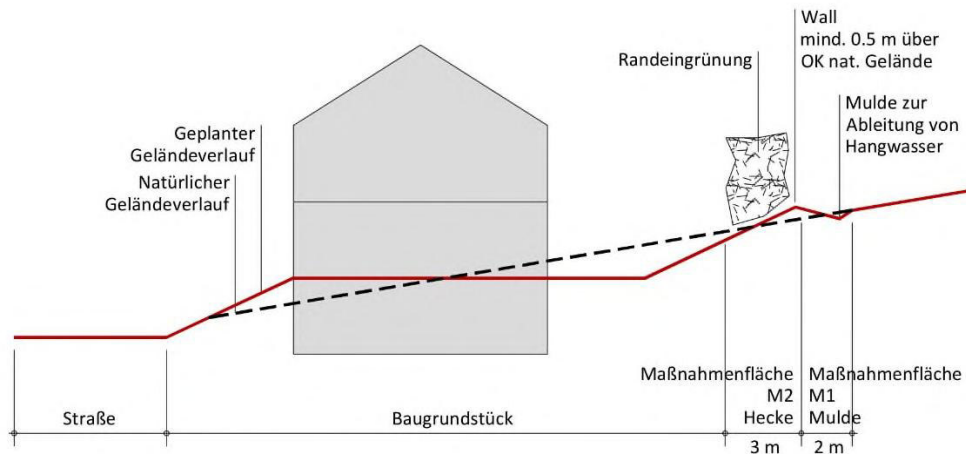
Schemaschnitt mit Wall- und Muldenbereich (Maßnahmenfläche 1 und 2)
